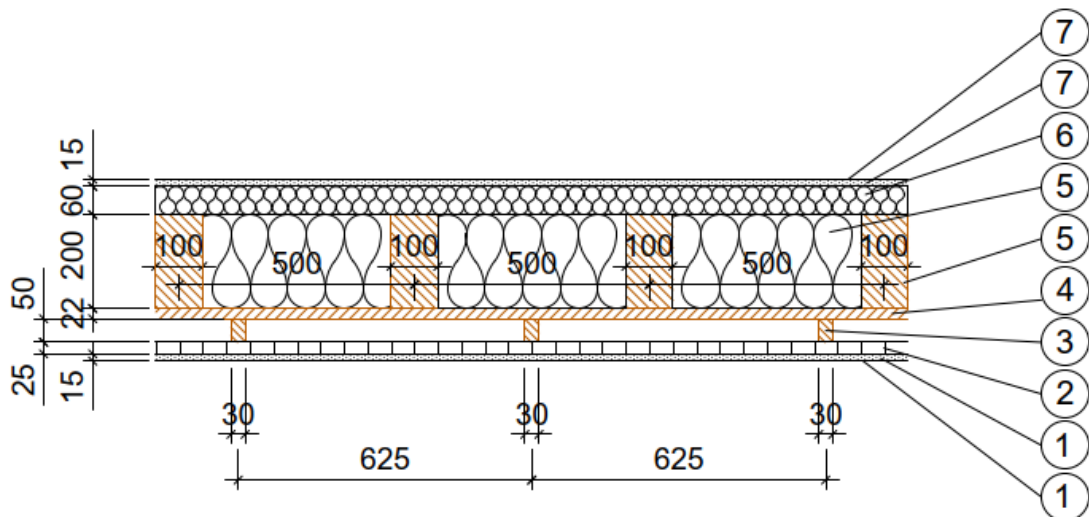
Holz-Ständer-Fassade mit Putzfassade
